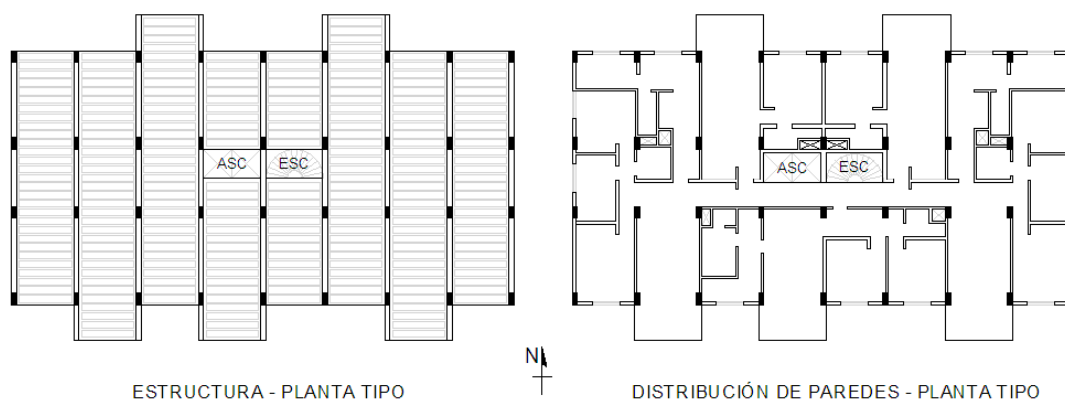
Edificio Belaire, planta tipo de estructura y arquitectura
